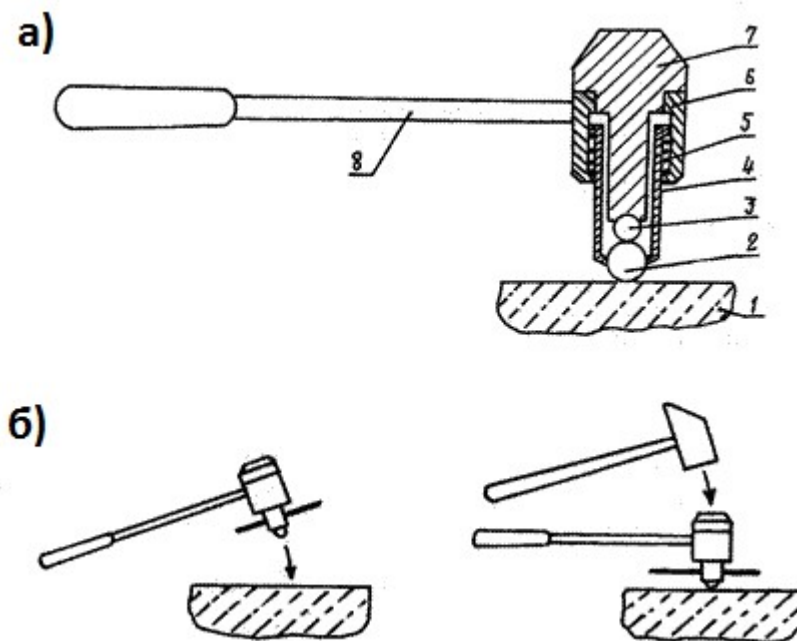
Схема молотку Кашкарова: а–загальний вигляд; б – схема нанесення удару; 1– бетон, що випробовується; 2 – індентор (кулька); 3 – еталонний стрижень; 4 – стакан; 5 –пружина; 6 – корпус; 7 – головка; 8 – ручка
